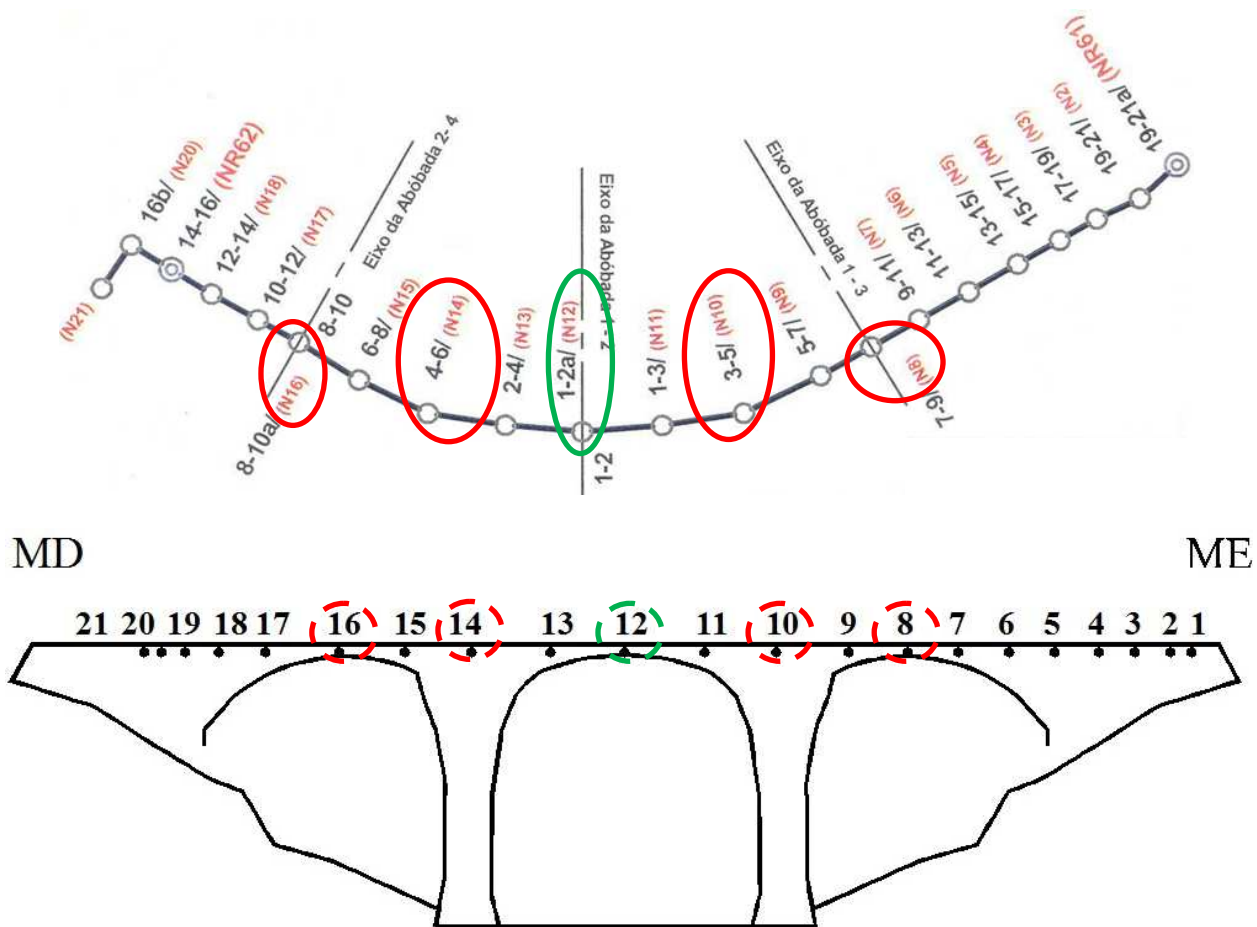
Planta e alçado longitudinal jusante das marcas de nivelamento, no coroamento.
